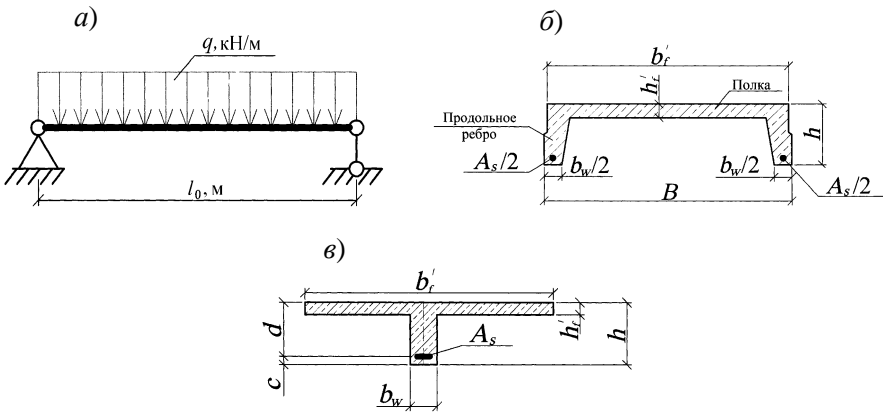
Расчетная схема (а), реальное (б) и расчетное (в) поперечные сечения ребристой плиты
